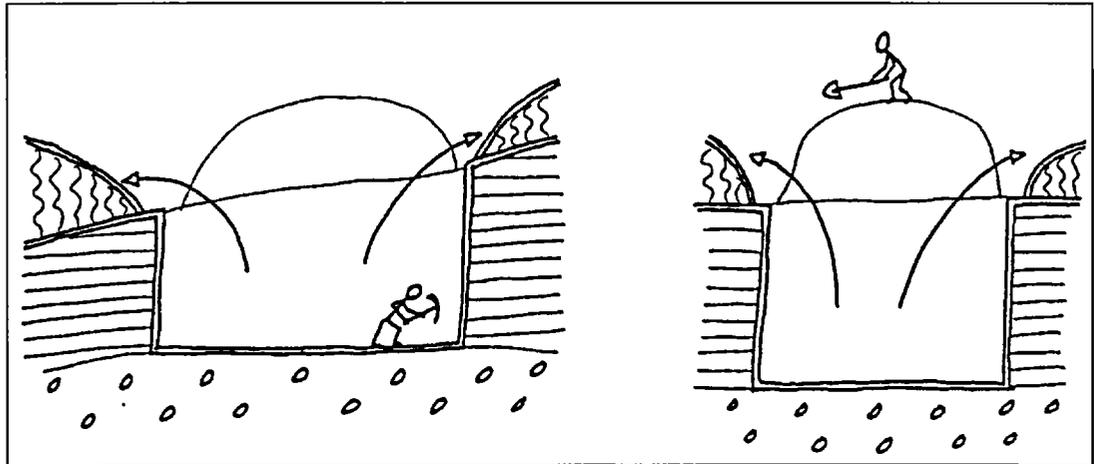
Excavation de la cave (coupes longitudinales à gauche, transversale à droite)
